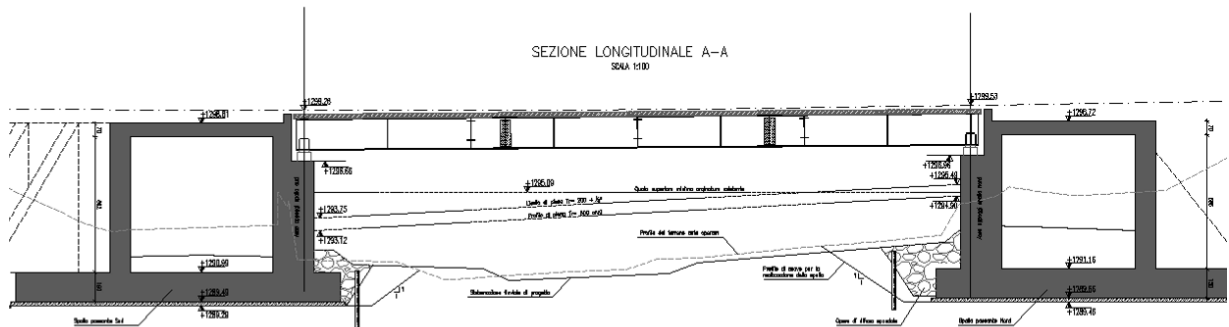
Sezione longitudinale del ponte con le spalle in evidenza
